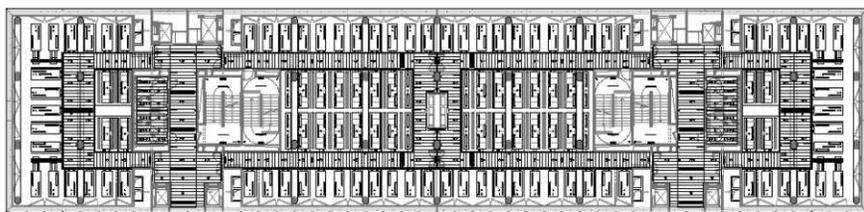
Grundriss nach der Sanierung, Hôtel Industriel Berlier
